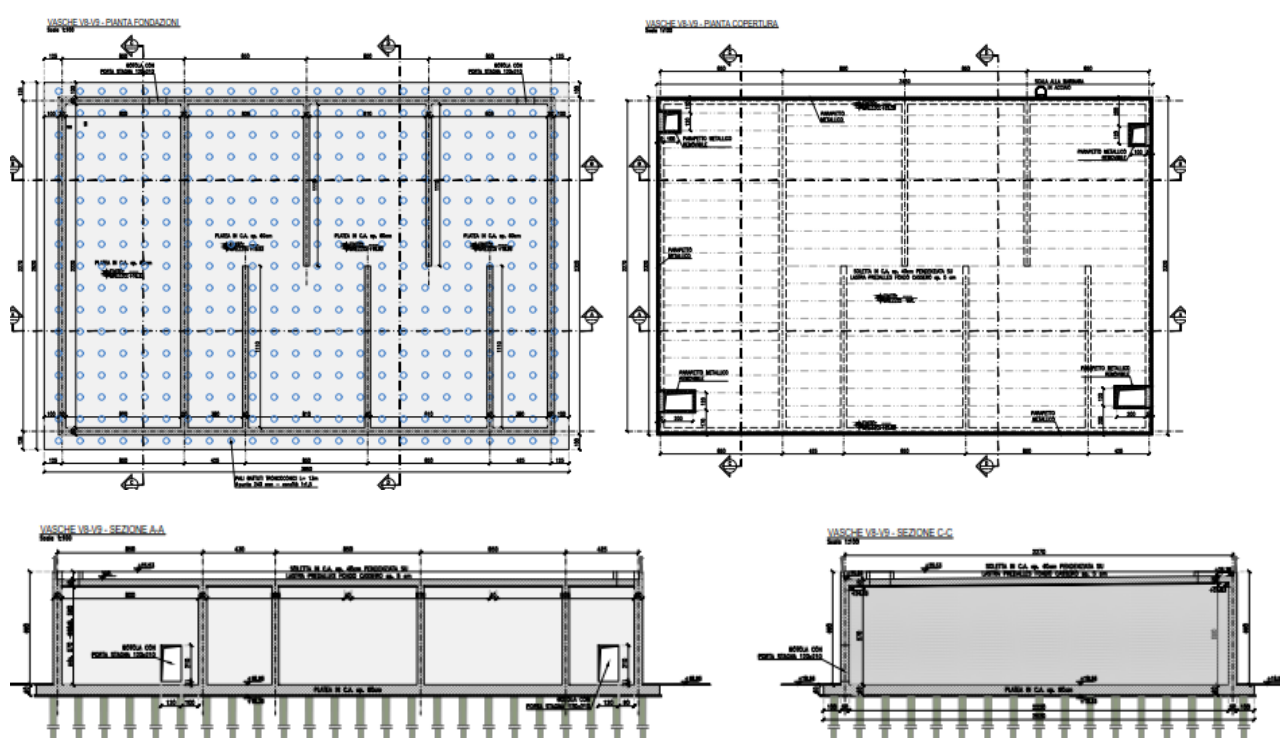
Pianta e sezioni delle vasche V8 e V9
